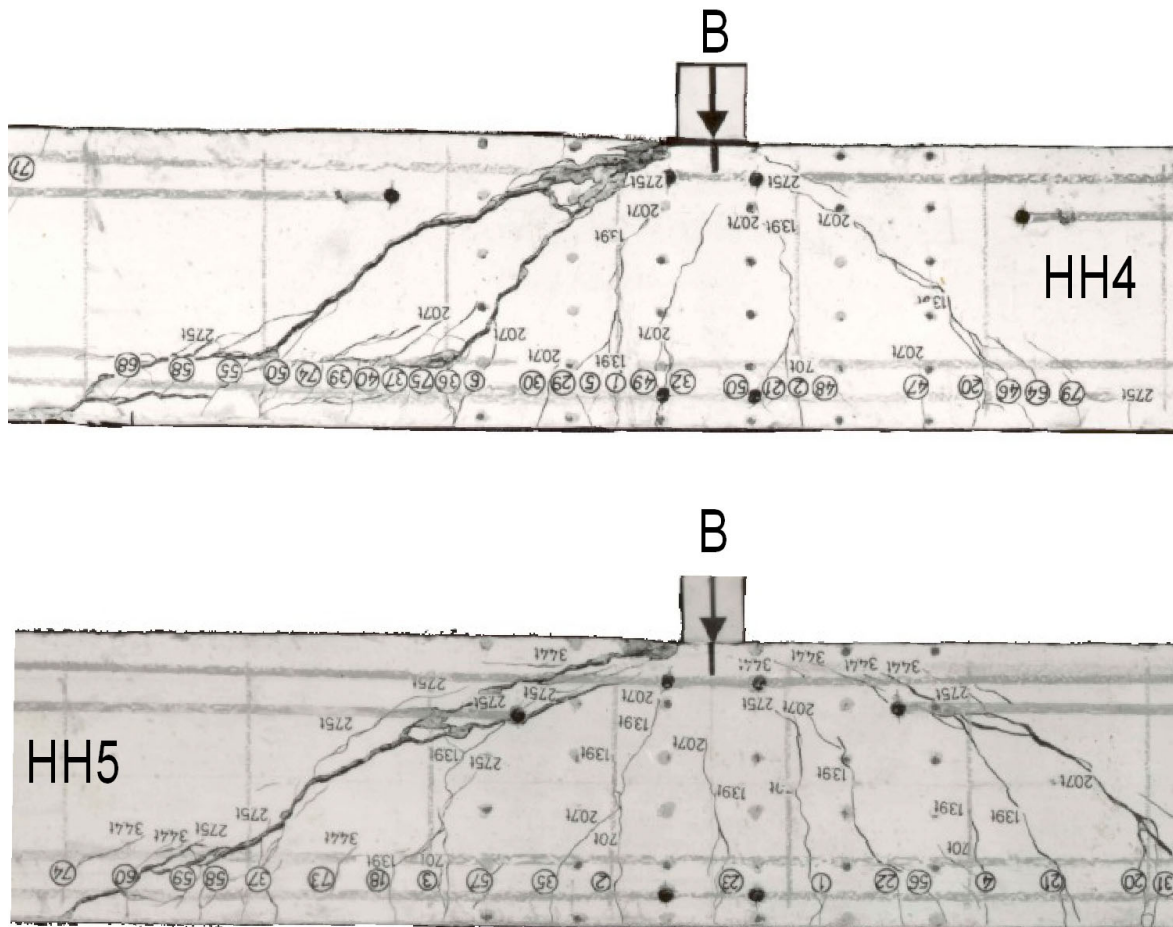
Rissbilder der Balken HH 4 und HH 5 aus [2.7] im Auflagerbereich B (die Balkenausschnitte sind kopfüber dargestellt)
